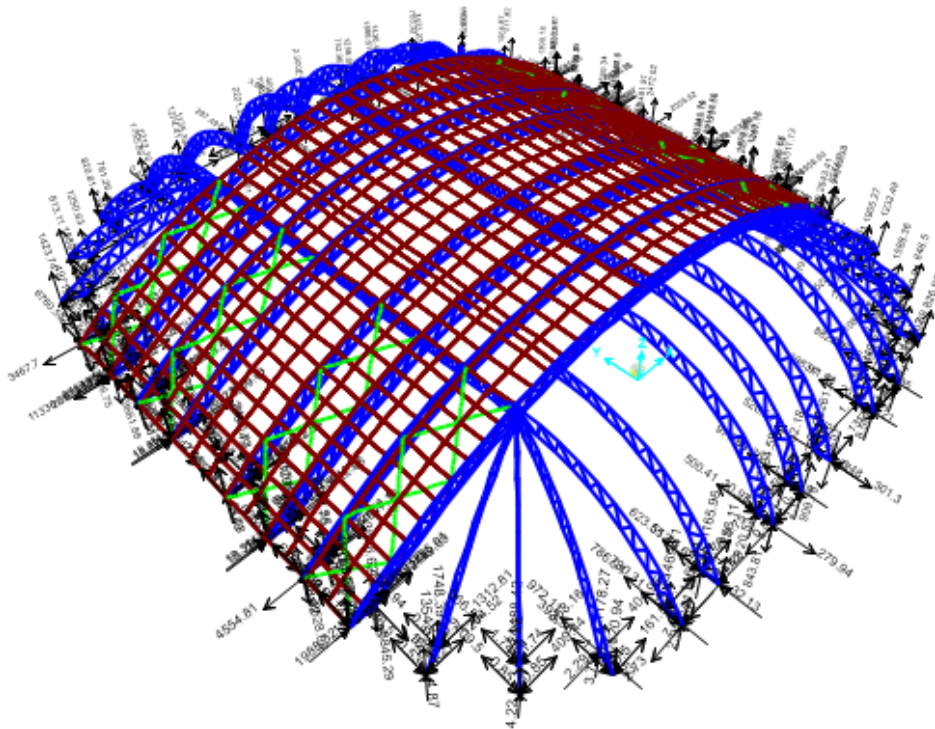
Reacciones de los apoyos de las vigas tipo arco. Fuente propia
